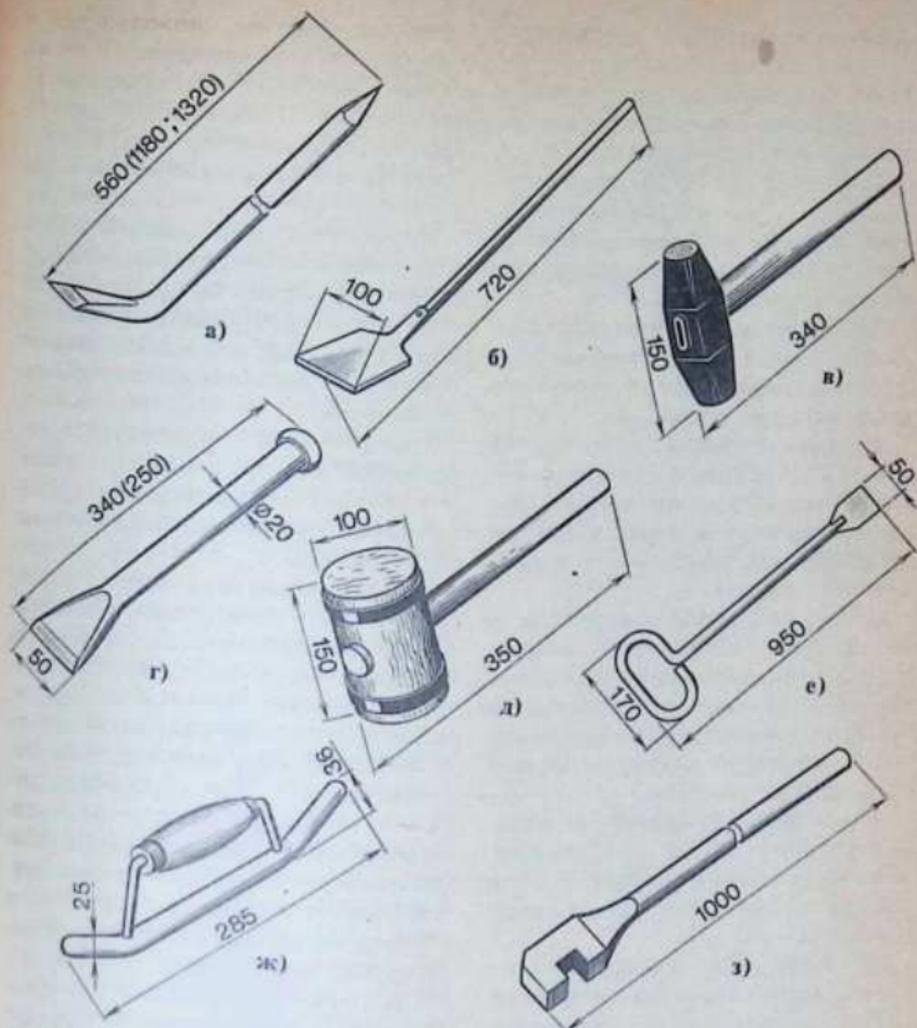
Ручной инструмент монтажника железобетонных конструкций:
